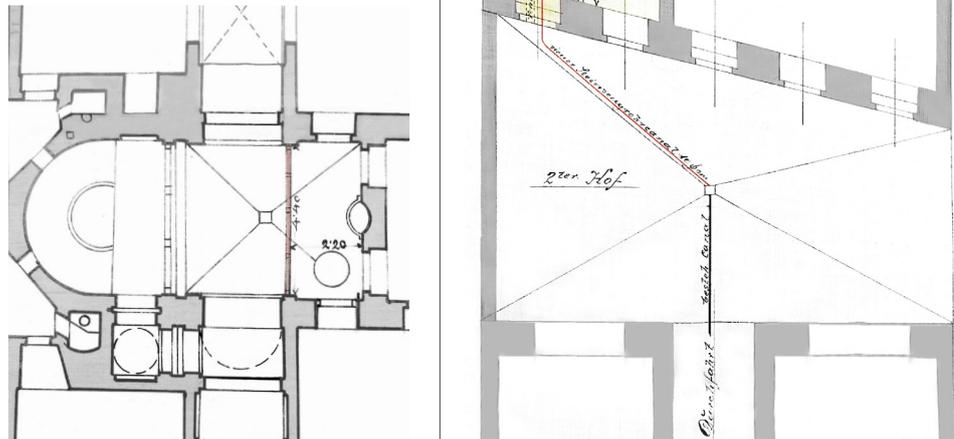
(rechts) Adaptierungsplan vom 14.10.1902, Grundriss
